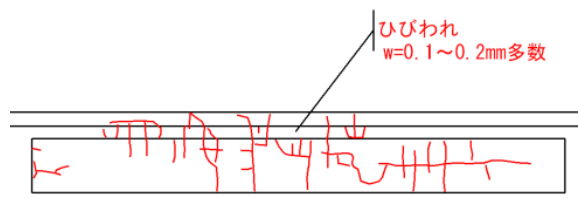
断面修復工（モルタル注入工法）の収縮ひび割れによる再劣化【事例】
